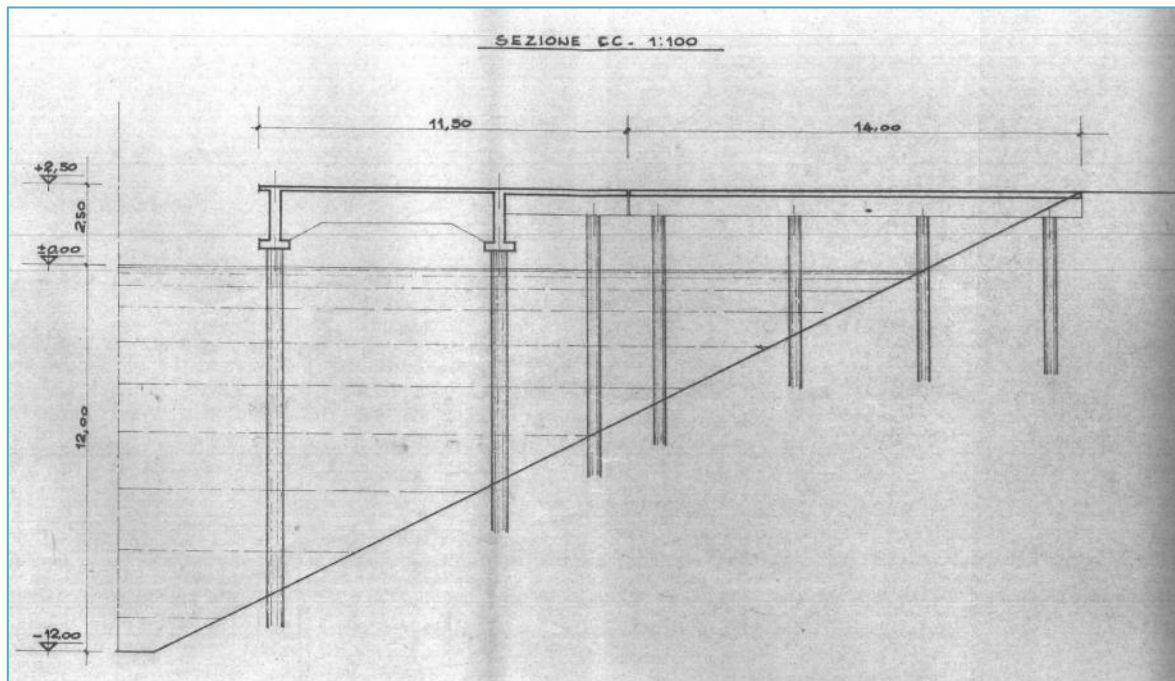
Sezione C-C dell'impalcato esistente (tratta da progetto originale 1968)
